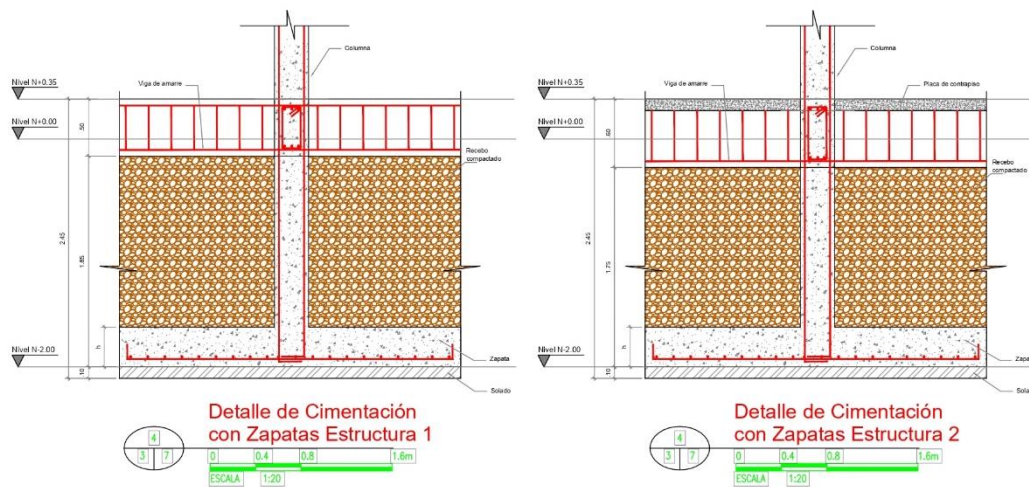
Detalle de Cimentación Con Zapatas. Fuente: Planos estructurales, proyecto Aulas Orientales Fase II.
